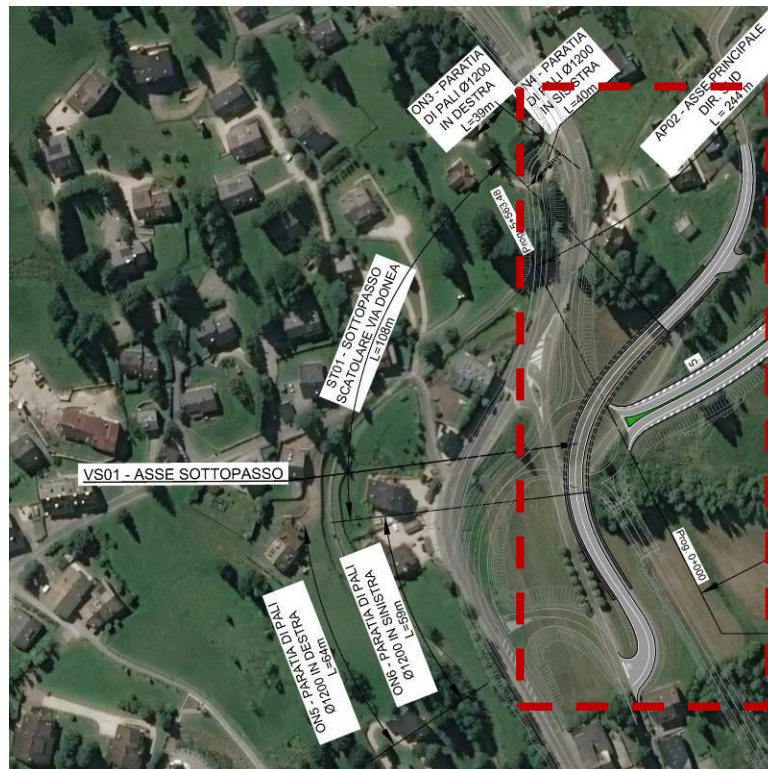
Planimetria asse di riconnessione Via Doneà – Via delle Guide Alpine
